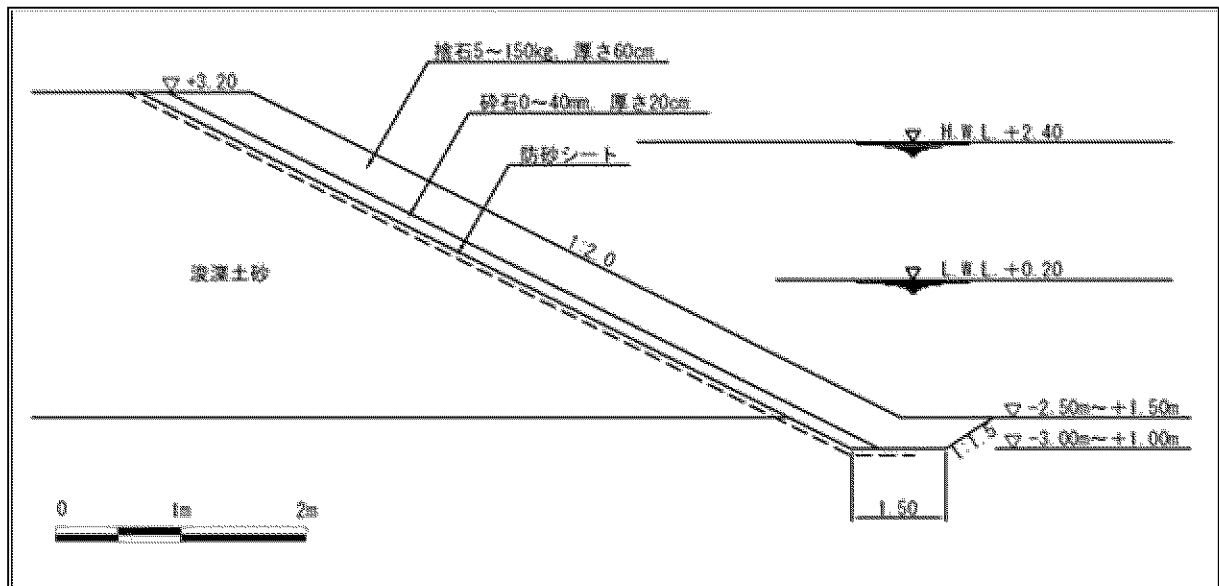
(18-2) 護岸の標準断面図 (護岸 B : 埠頭西側端部)
